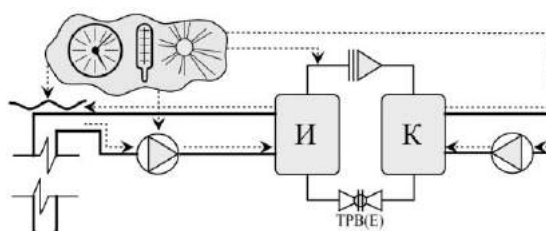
Схема теплонасосной системы теплоснабжения с грунтовым теплообменником
